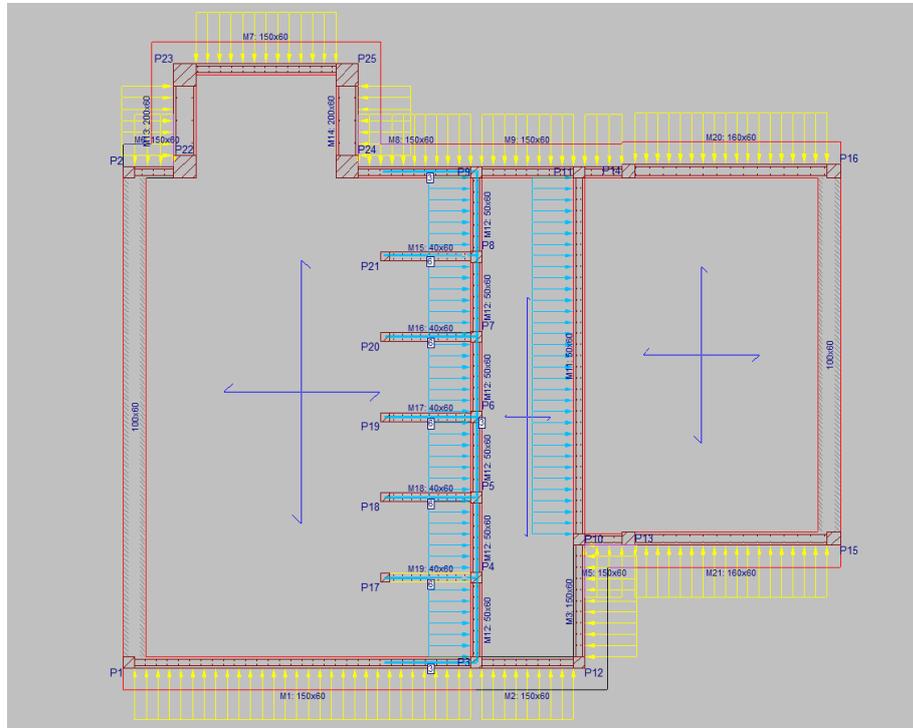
Vista de planta de la almenara, con los empujes sobre muros con la obra terminada.
